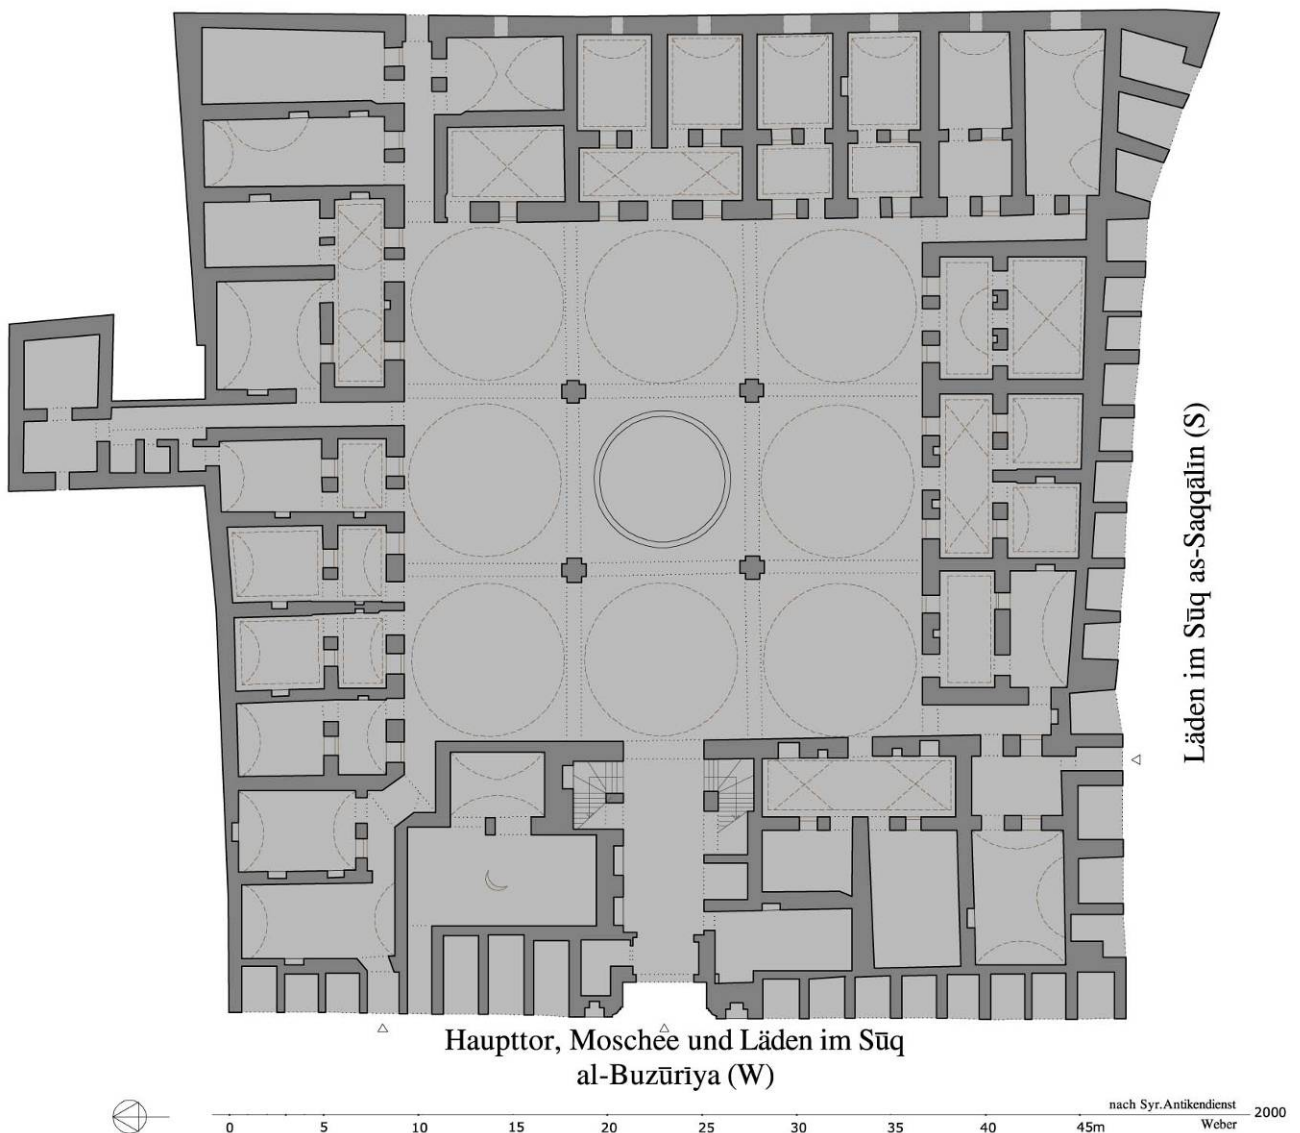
Ḥān As'ad Bāšā al-'Azm, Grundriss EG
